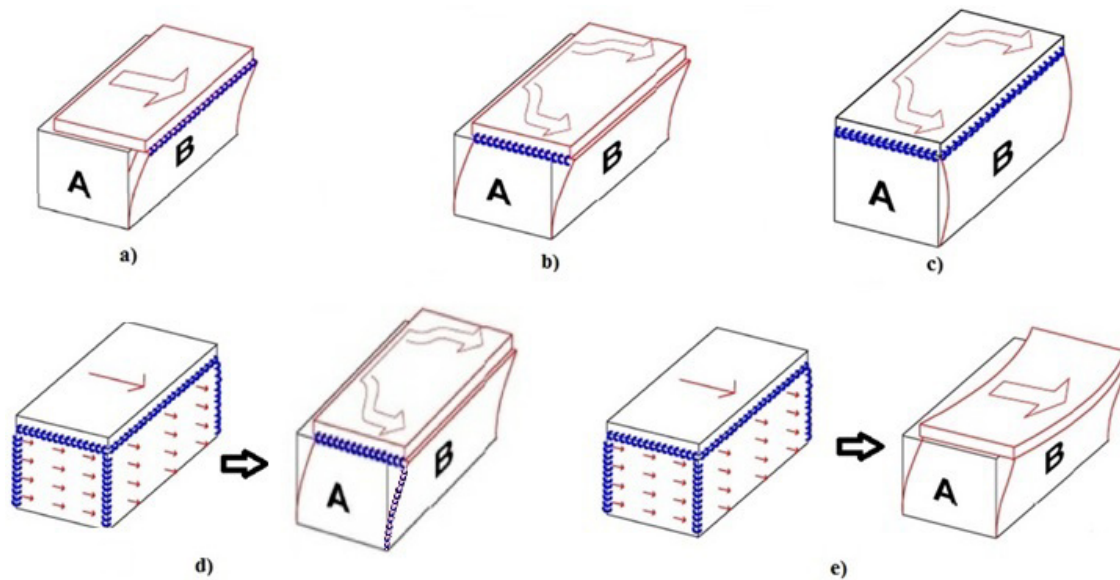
a) vinculação entre um pavimento rígido e a parede B; b) vinculação entre um pavimento rígido e a parede A; c) vinculação do pavimento rígido com todas as paredes; d) vinculação entre paredes A e B e entre paredes e pavimento rígido; e) vinculação entre paredes A e paredes B e entre paredes e pavimento flexível; (S.T.A. Data, 2012)
